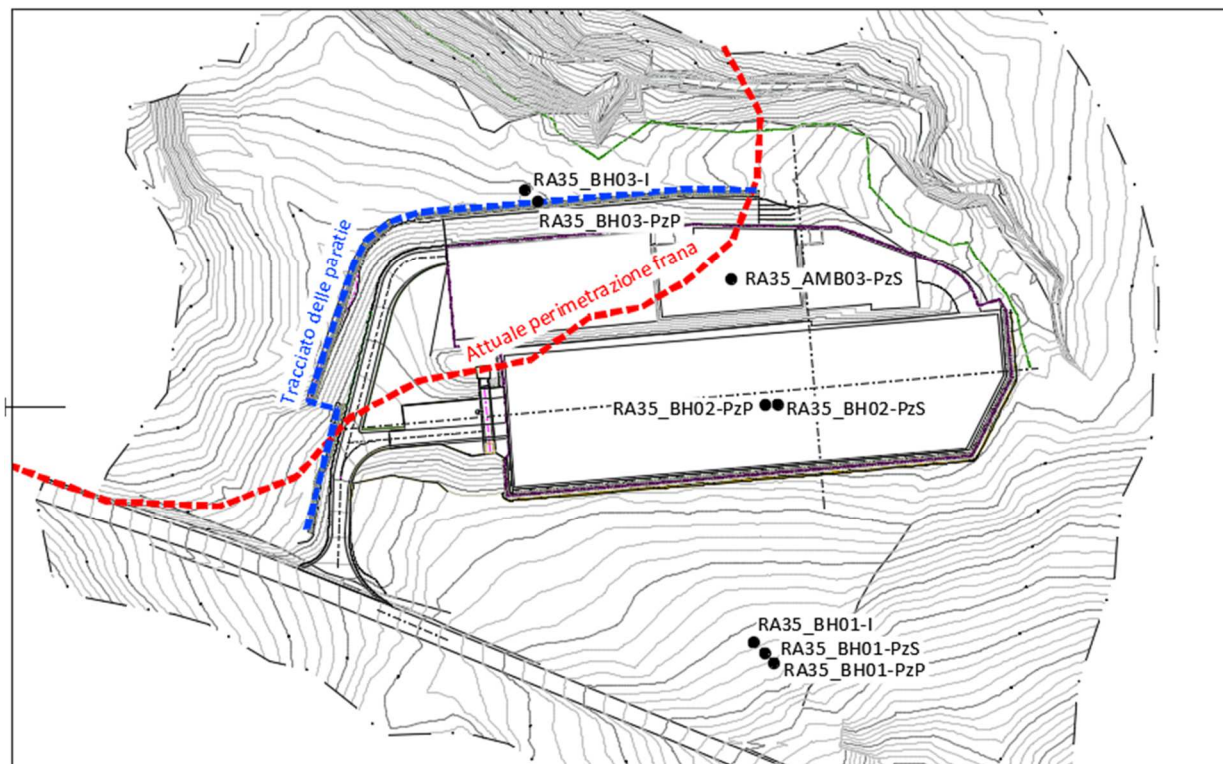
Planimetria con ubicazione della strumentazione geotecnica.
